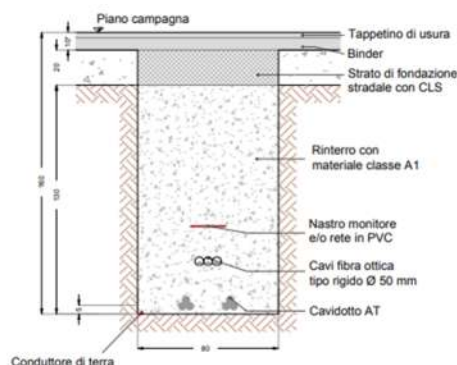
Sezione tipo di posa del cavidotto AT sotto strada in asfalto (misure in cm)
